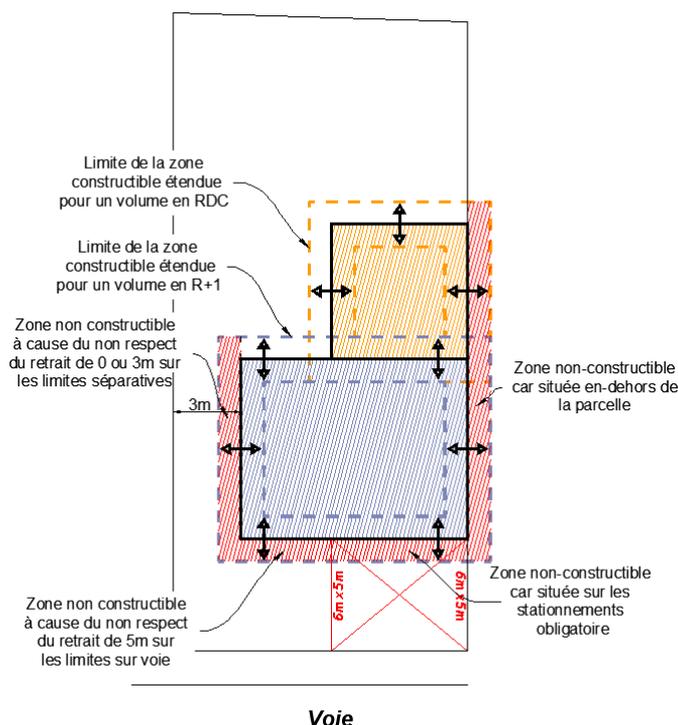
Schéma représentant sur quelques cas la règles d'extension des zones constructibles
